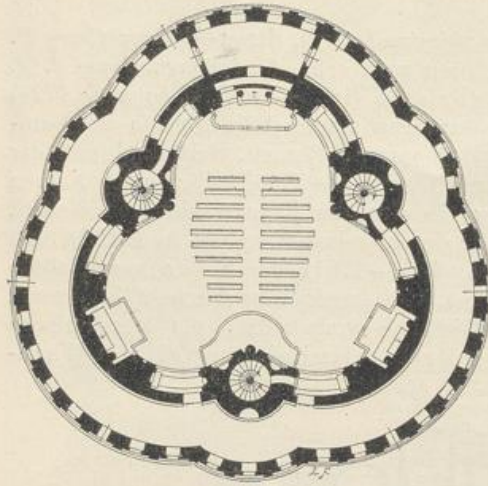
Grundriss der Dreifaltigkeitskapelle bei Waldsassen
